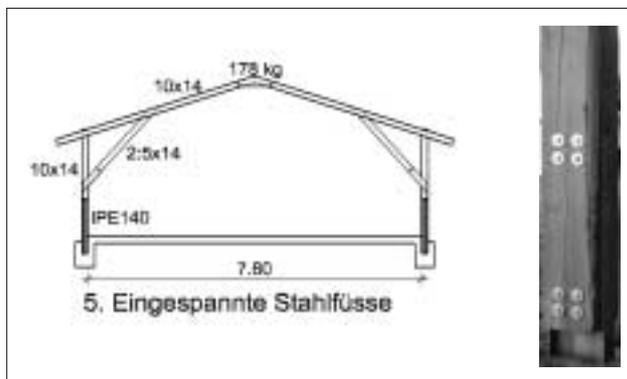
Schlanker Dachbinder in verlängerten eingespannten Stahlfüssen (IPE) befestigt.
